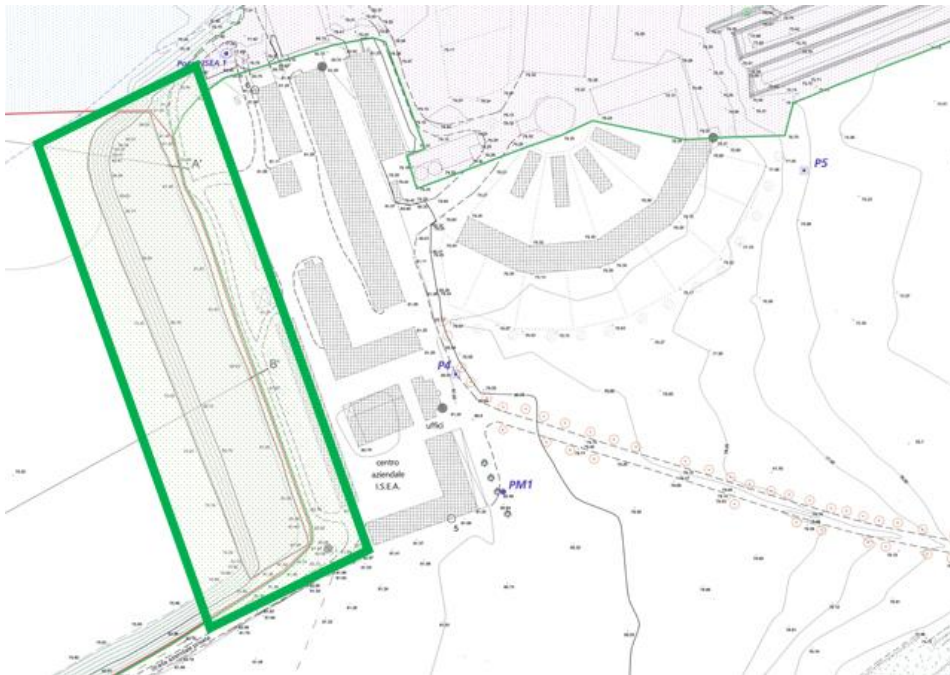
Pianta area di contaminazione individuata dall'ARPAM.
